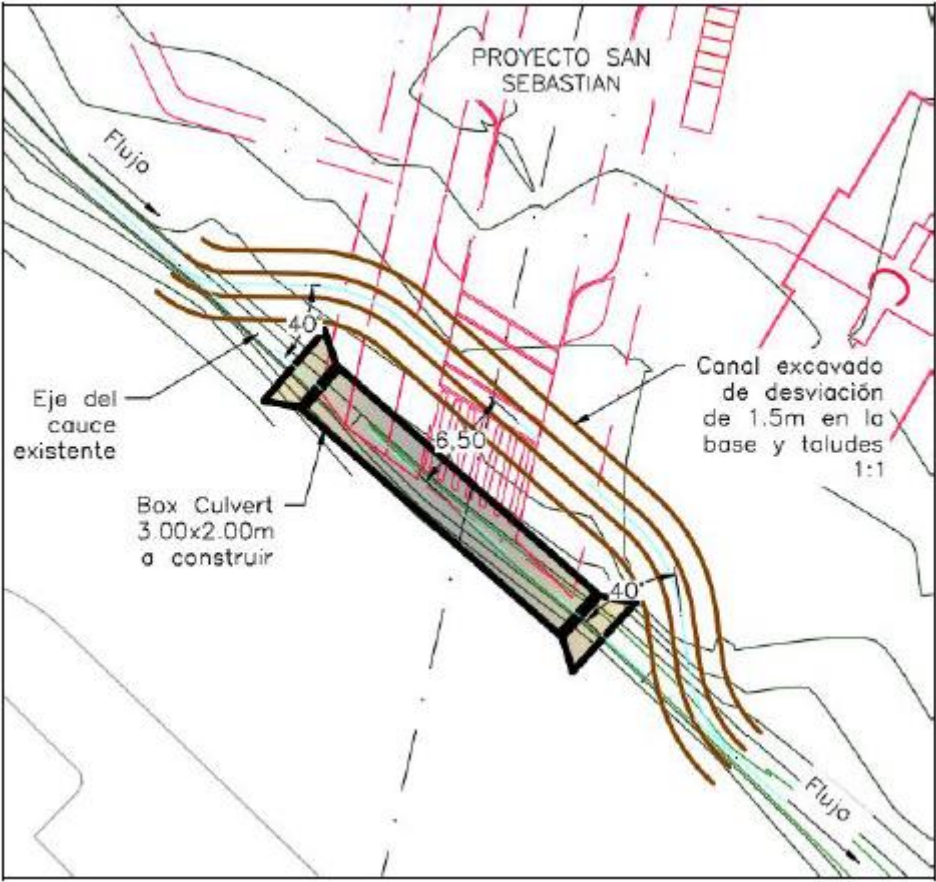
Planta de Canal de desvío provisional para los Box Culvert N°1, 2, 3 y 4
